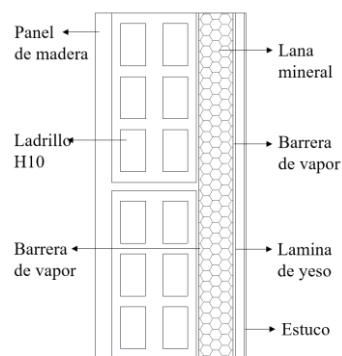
Detalle en 3D de fachada de ladrillo con aislamiento de lana mineral
